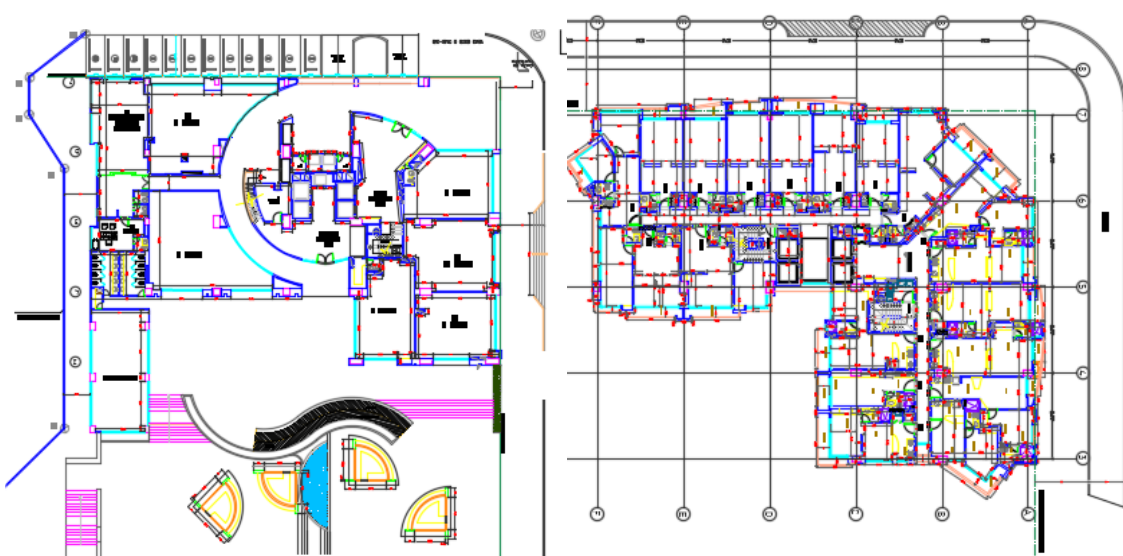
Planta arquitectónica 1er piso y Piso Tipo
